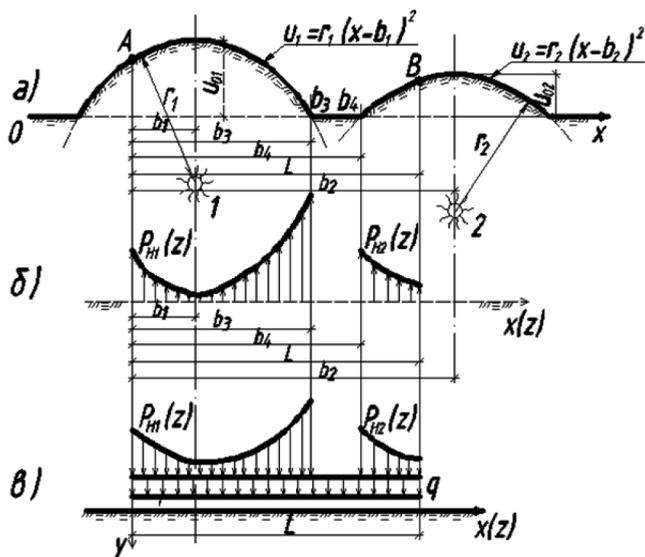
Двухбугровая поверхность набухания (а); эпюры набухающих давлений (б); расчетная схема двухбугровых непересекающихся бугров набухания эквивалентной нагрузки от силы набухания  $P_H(x)$  фундаментной балки (в)
